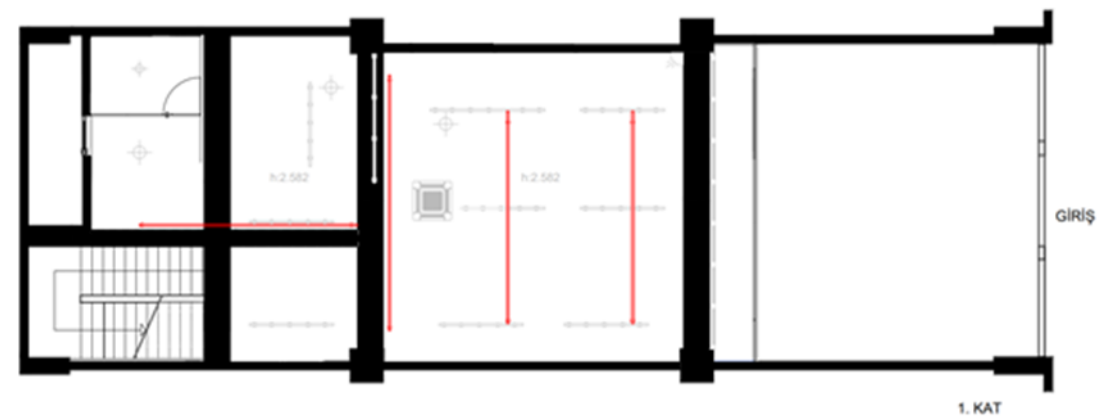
Vivense Beylikdüzü mağaza giriş kat planı
